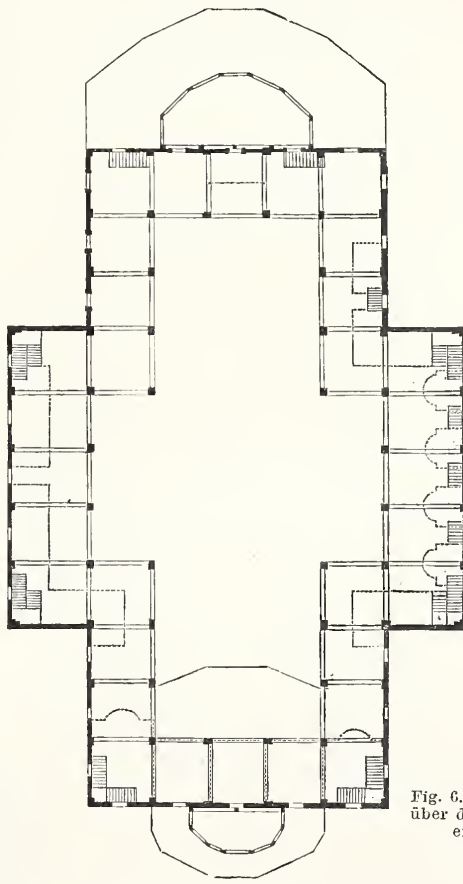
Grundriss über der I. Hauptempore.
